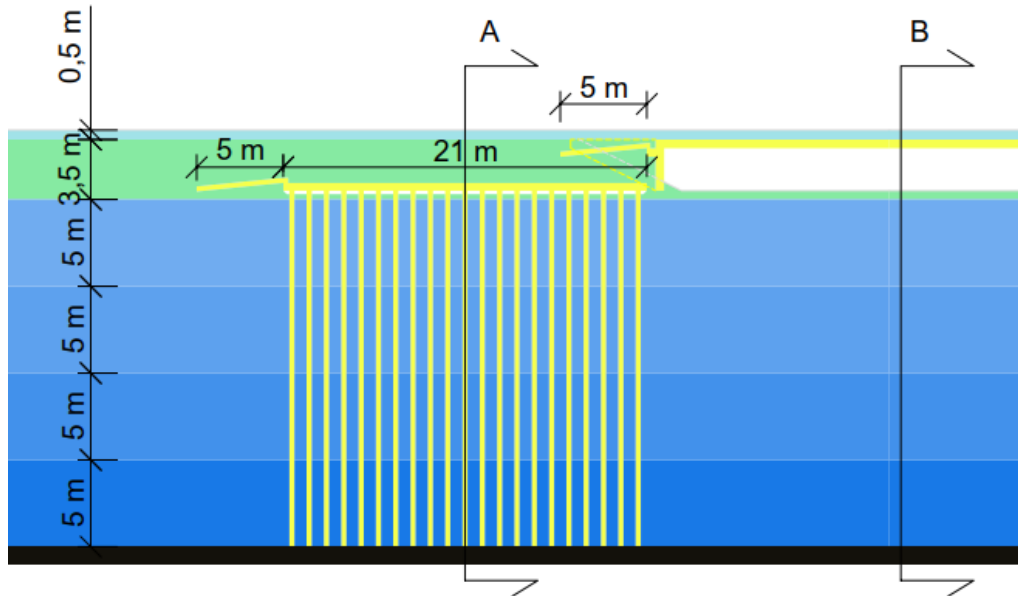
3D-esitys sillan ja paalulaatan betonirakenteista laskentamallissa. Paalulaatta on 6 m leveä ja 21 m pitkä. Silta 6,8 m leveä ja 26 m pitkä. Molempien rakenteiden päässä olevat siirtymälaatat ovat 5 m pitkiä.
